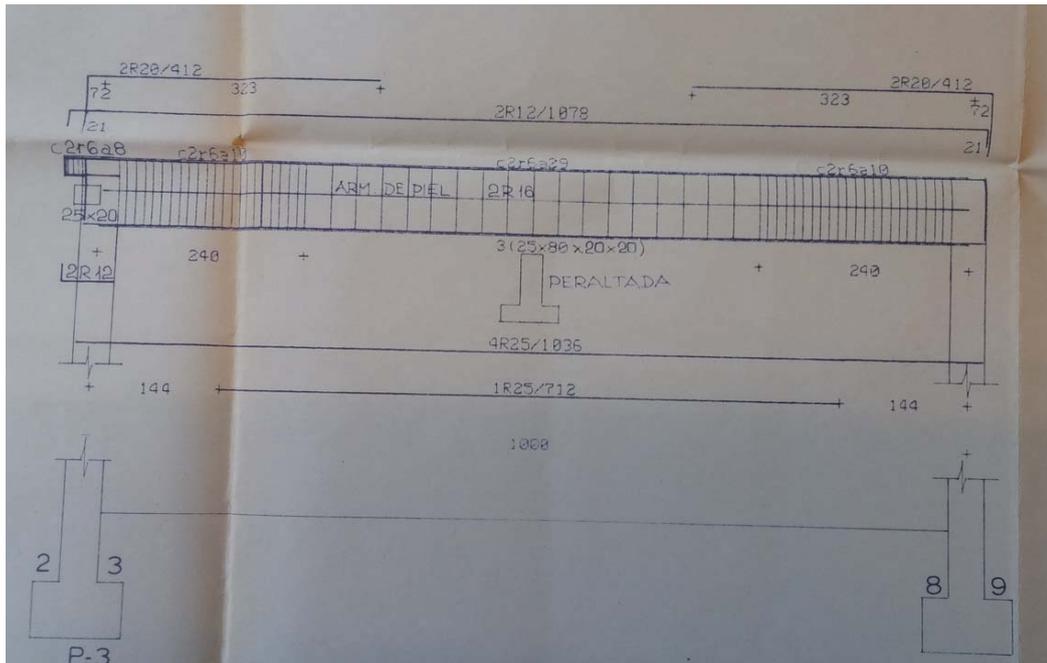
Plano de forjado de proyecto que recoge el pórtico P3 con las vigas peraltadas.
